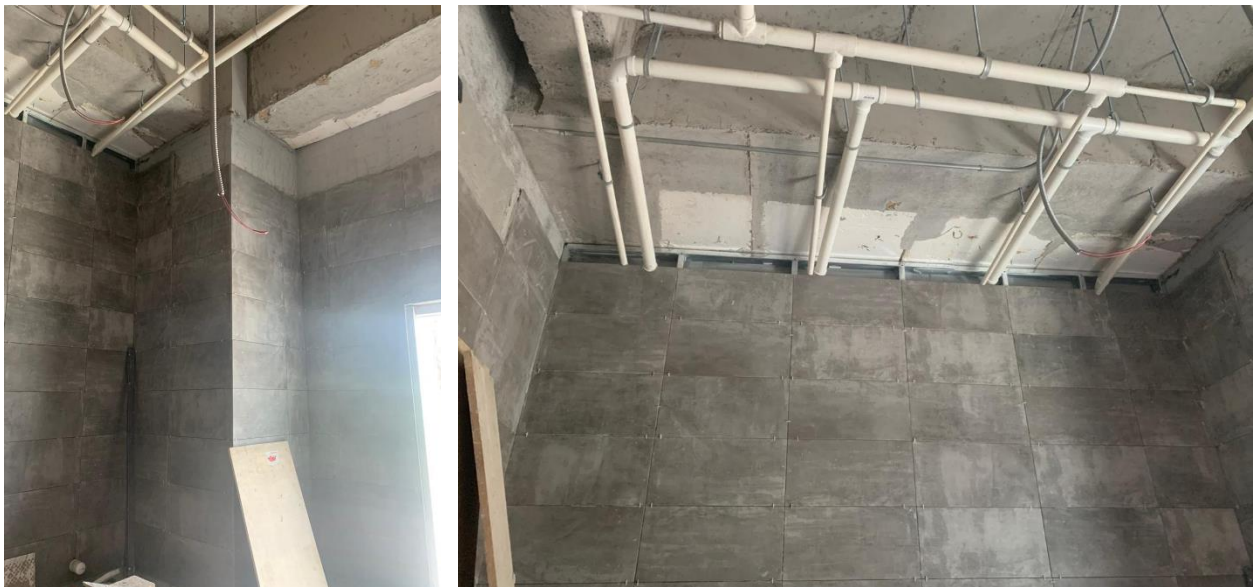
Avance de obra en baño de caballeros, Torre 3
